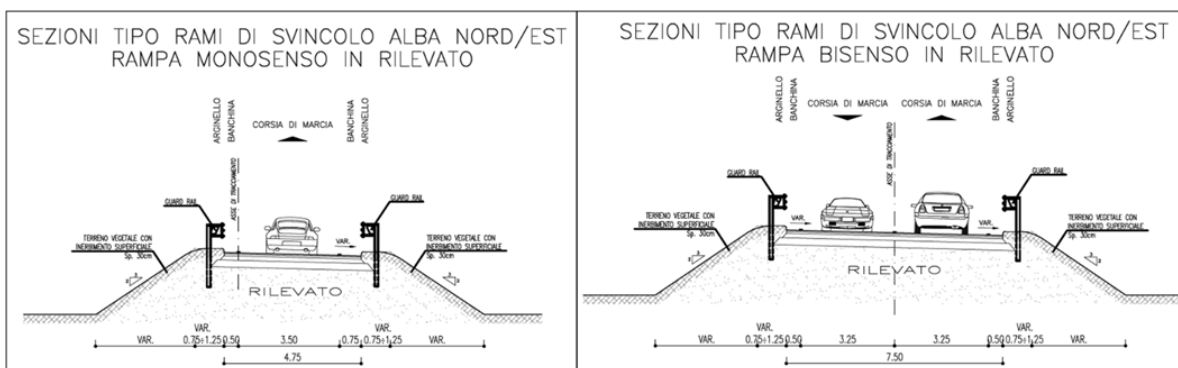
Sezione tipo asse stradale lungo le rampe degli svincoli
